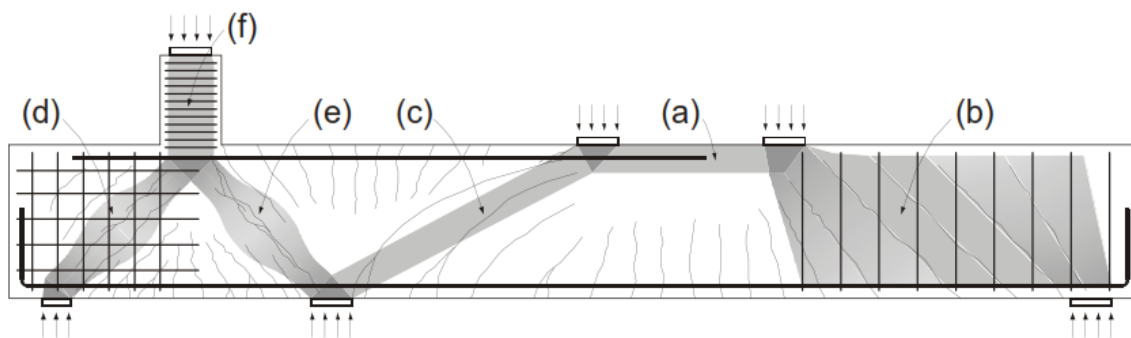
Tipos de biela en una región de discontinuidad (a) biela prismática no fisurada (b) biela prismática con fisuración paralela a las bielas (c) biela prismática con fisuración no paralela a las bielas (d) biela en botella en zona fisurada armada (e) biela en botella en zona fisurada no armada y (f) biela confinada (Tjhin y Kuchma (2002) [47])
